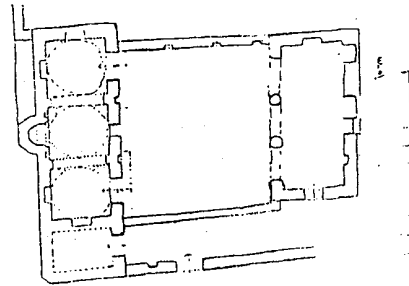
مسقط أفقى لمسجد ومدرسة
